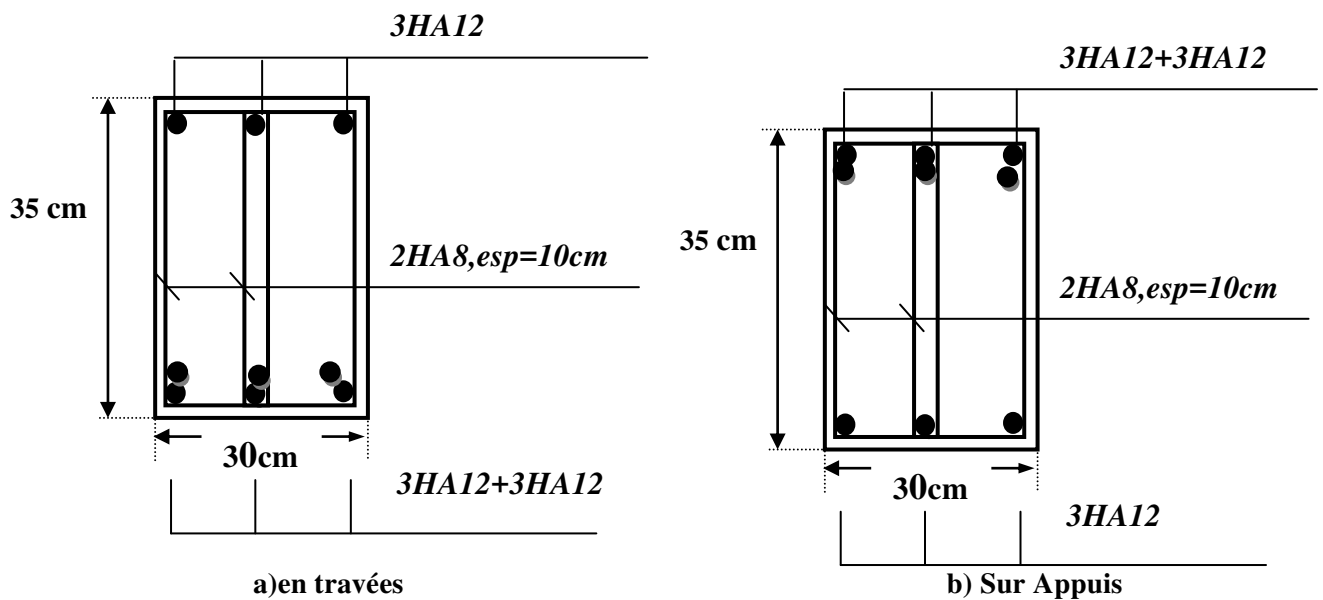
schéma de ferrailage des poutres secondaires (30x35)cm²
